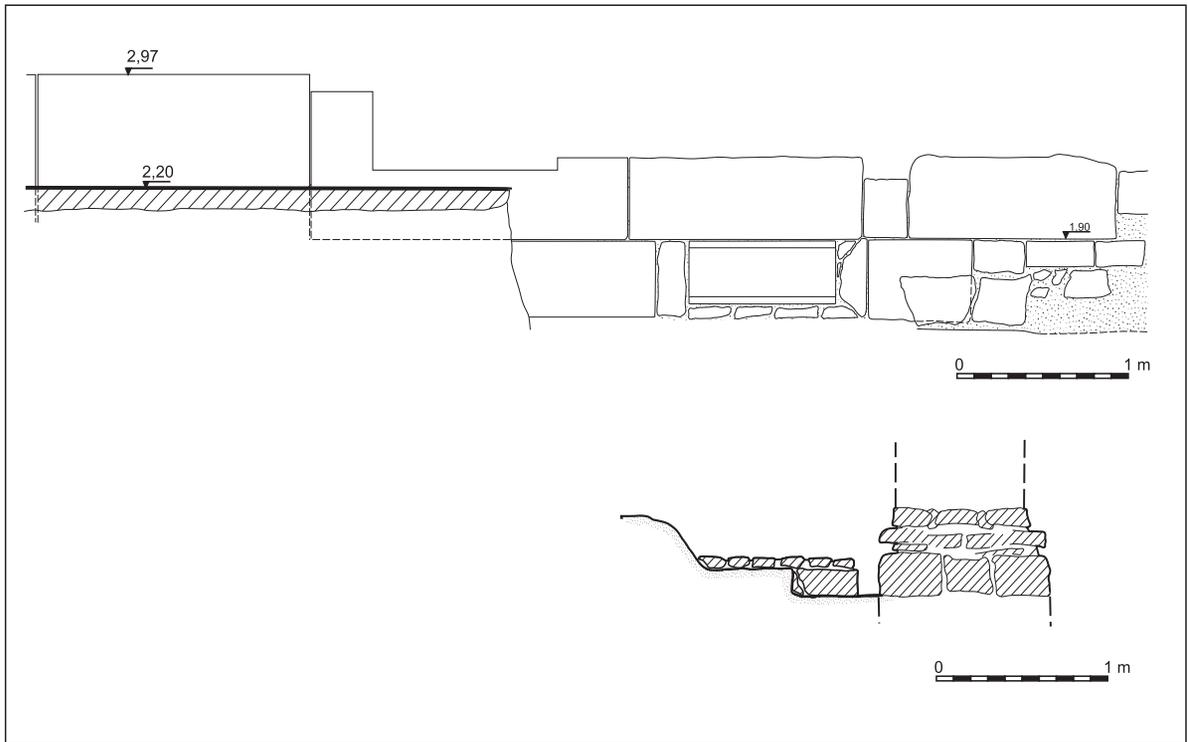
La rencontre du mur est avec le mur nord, état tétrarchique
